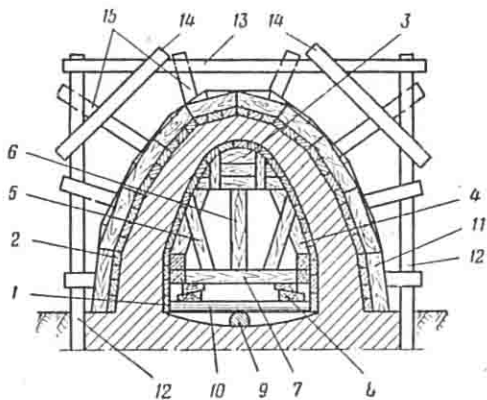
Схема кружал для возведения каменных, бетонных и железобетонных монолитных труб:
